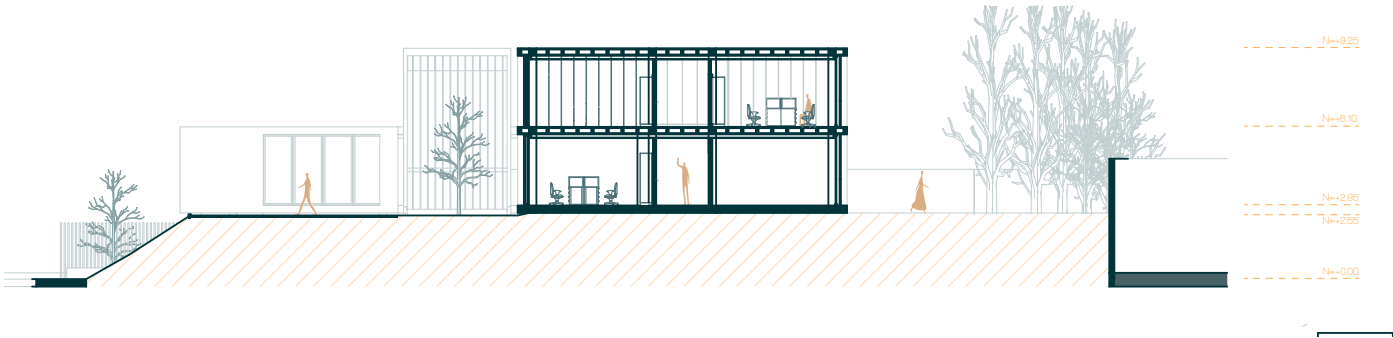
Sección D-D, Bloque B (Autores, 2023)
